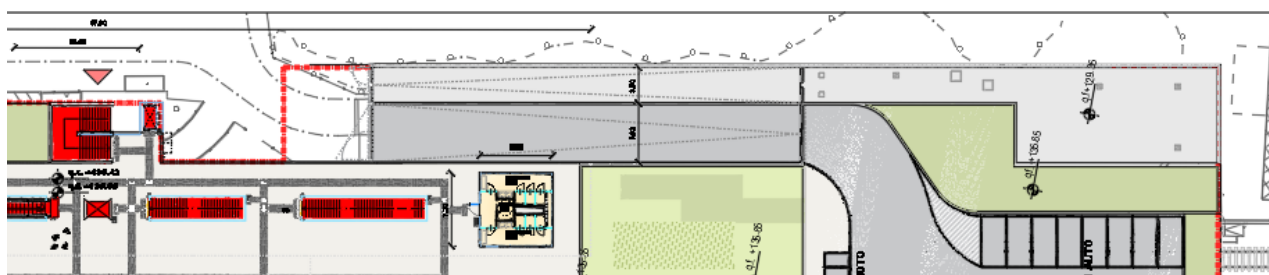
Estratto planimetria di inquadramento dell'ingresso est (lato sud)
